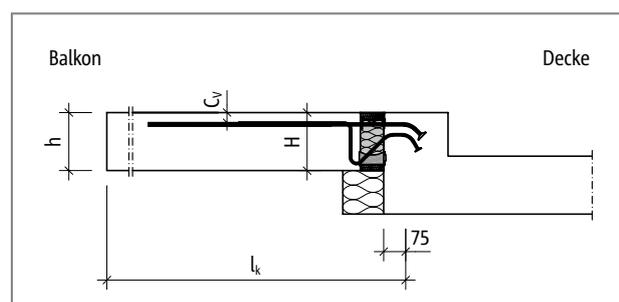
Schöck Isokorb® T Typ KL-O: Statisches System
